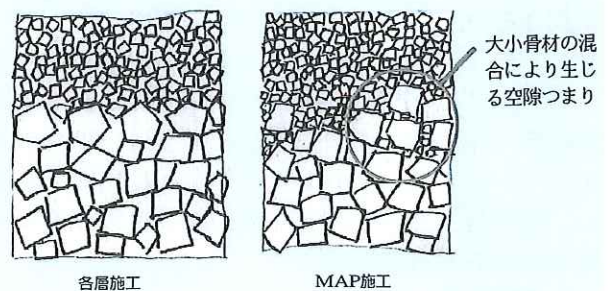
各層施工とMAP施工により敷設した二層式排水性舗装の断面構造の違い
